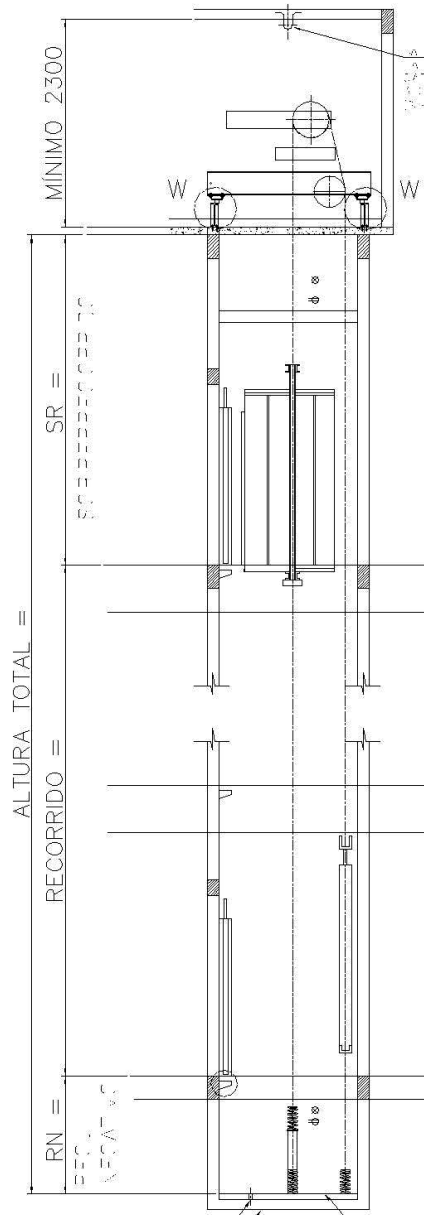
Vista en planta típica de un ascensor a tracción con suspensión 1:1.
